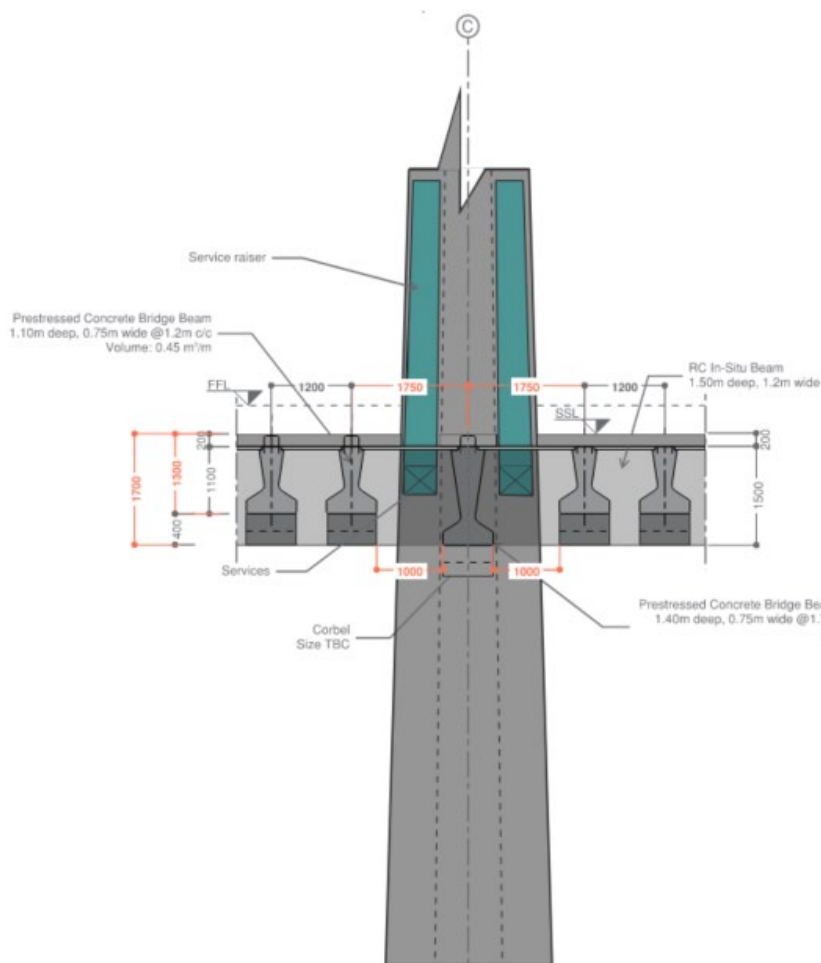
Tipica disposizione della trave a ponte prefabbricata davanti alla mega colonna con condotti di ventilazione
